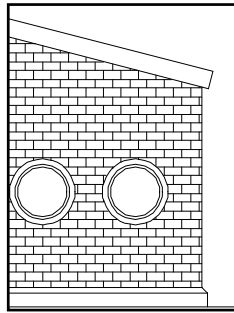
/5a: Pumpwerk Hohenwarthe - Sockel und Fensterleibung -Beton -FT - Entwurf & Ausführung-
